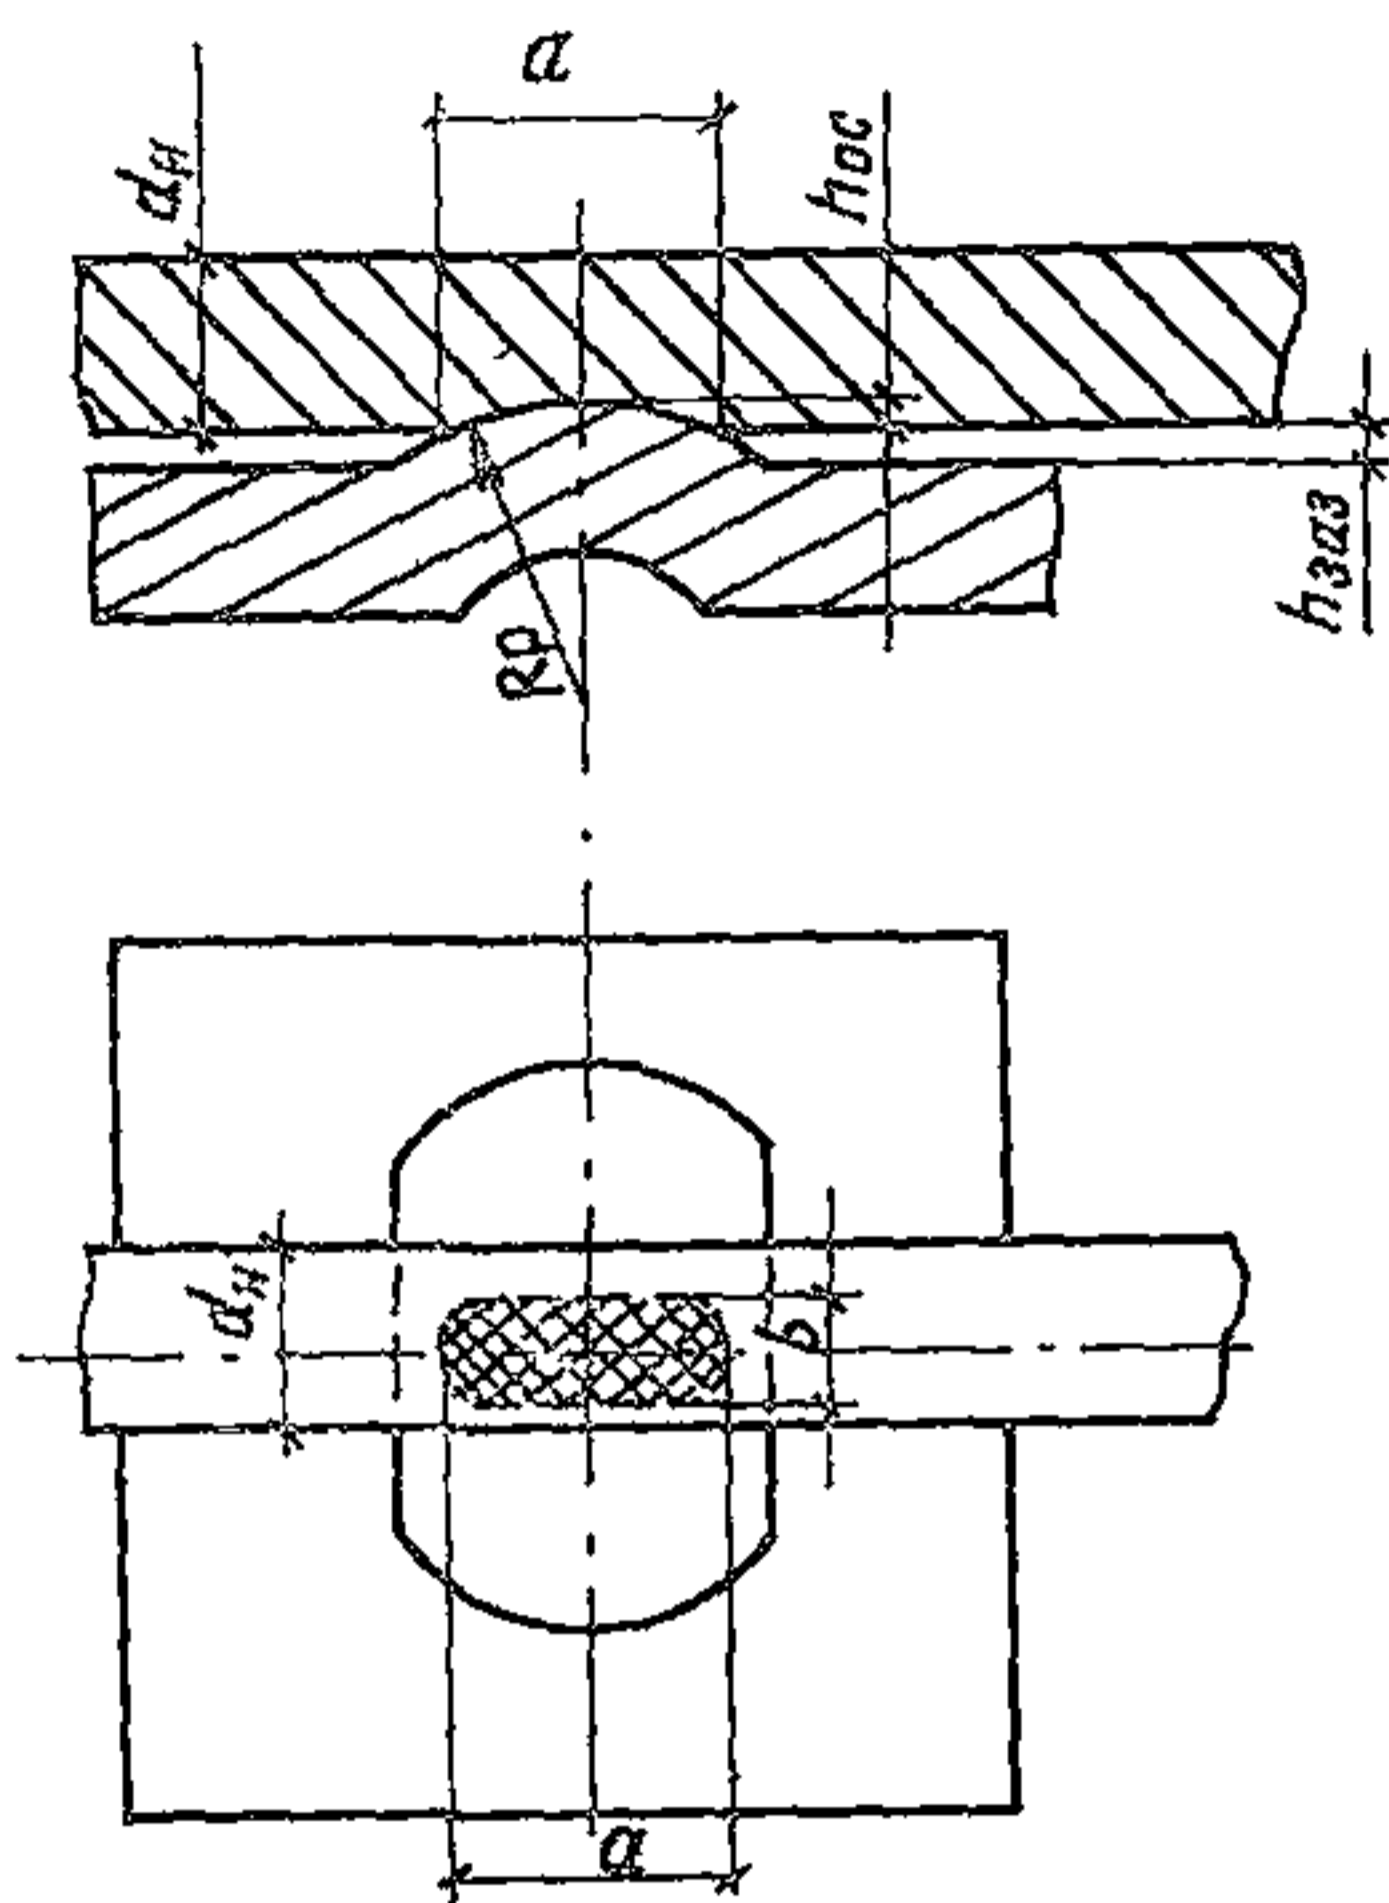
Схема нахлесточного соединения закладной детали для расчета площади сварной точки
